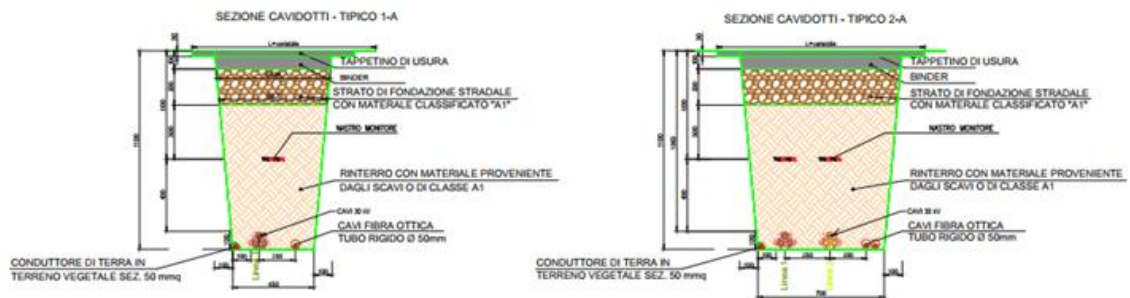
Sezioni tipo di posa del cavidotto su terreno vegetale, strada sterrata e asfalto
